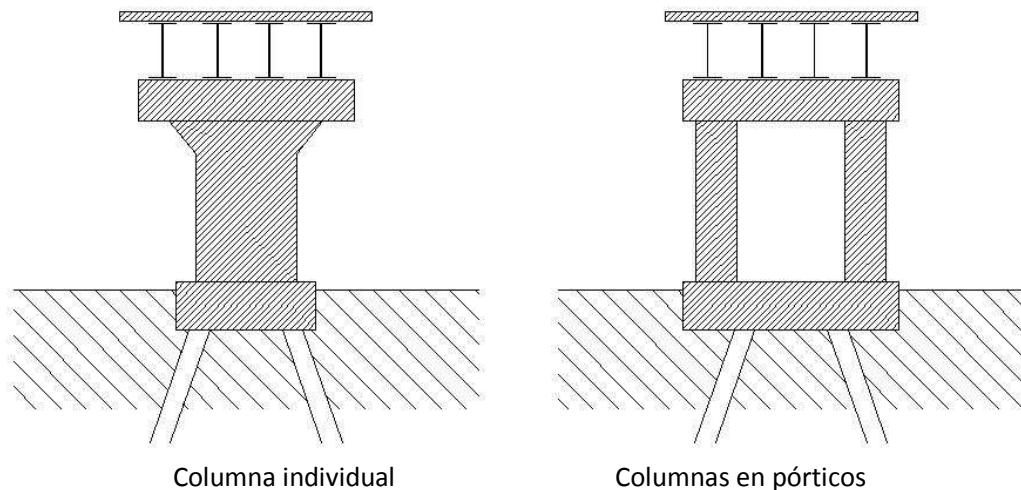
Subestructuras típicas de puentes en concreto reforzado
